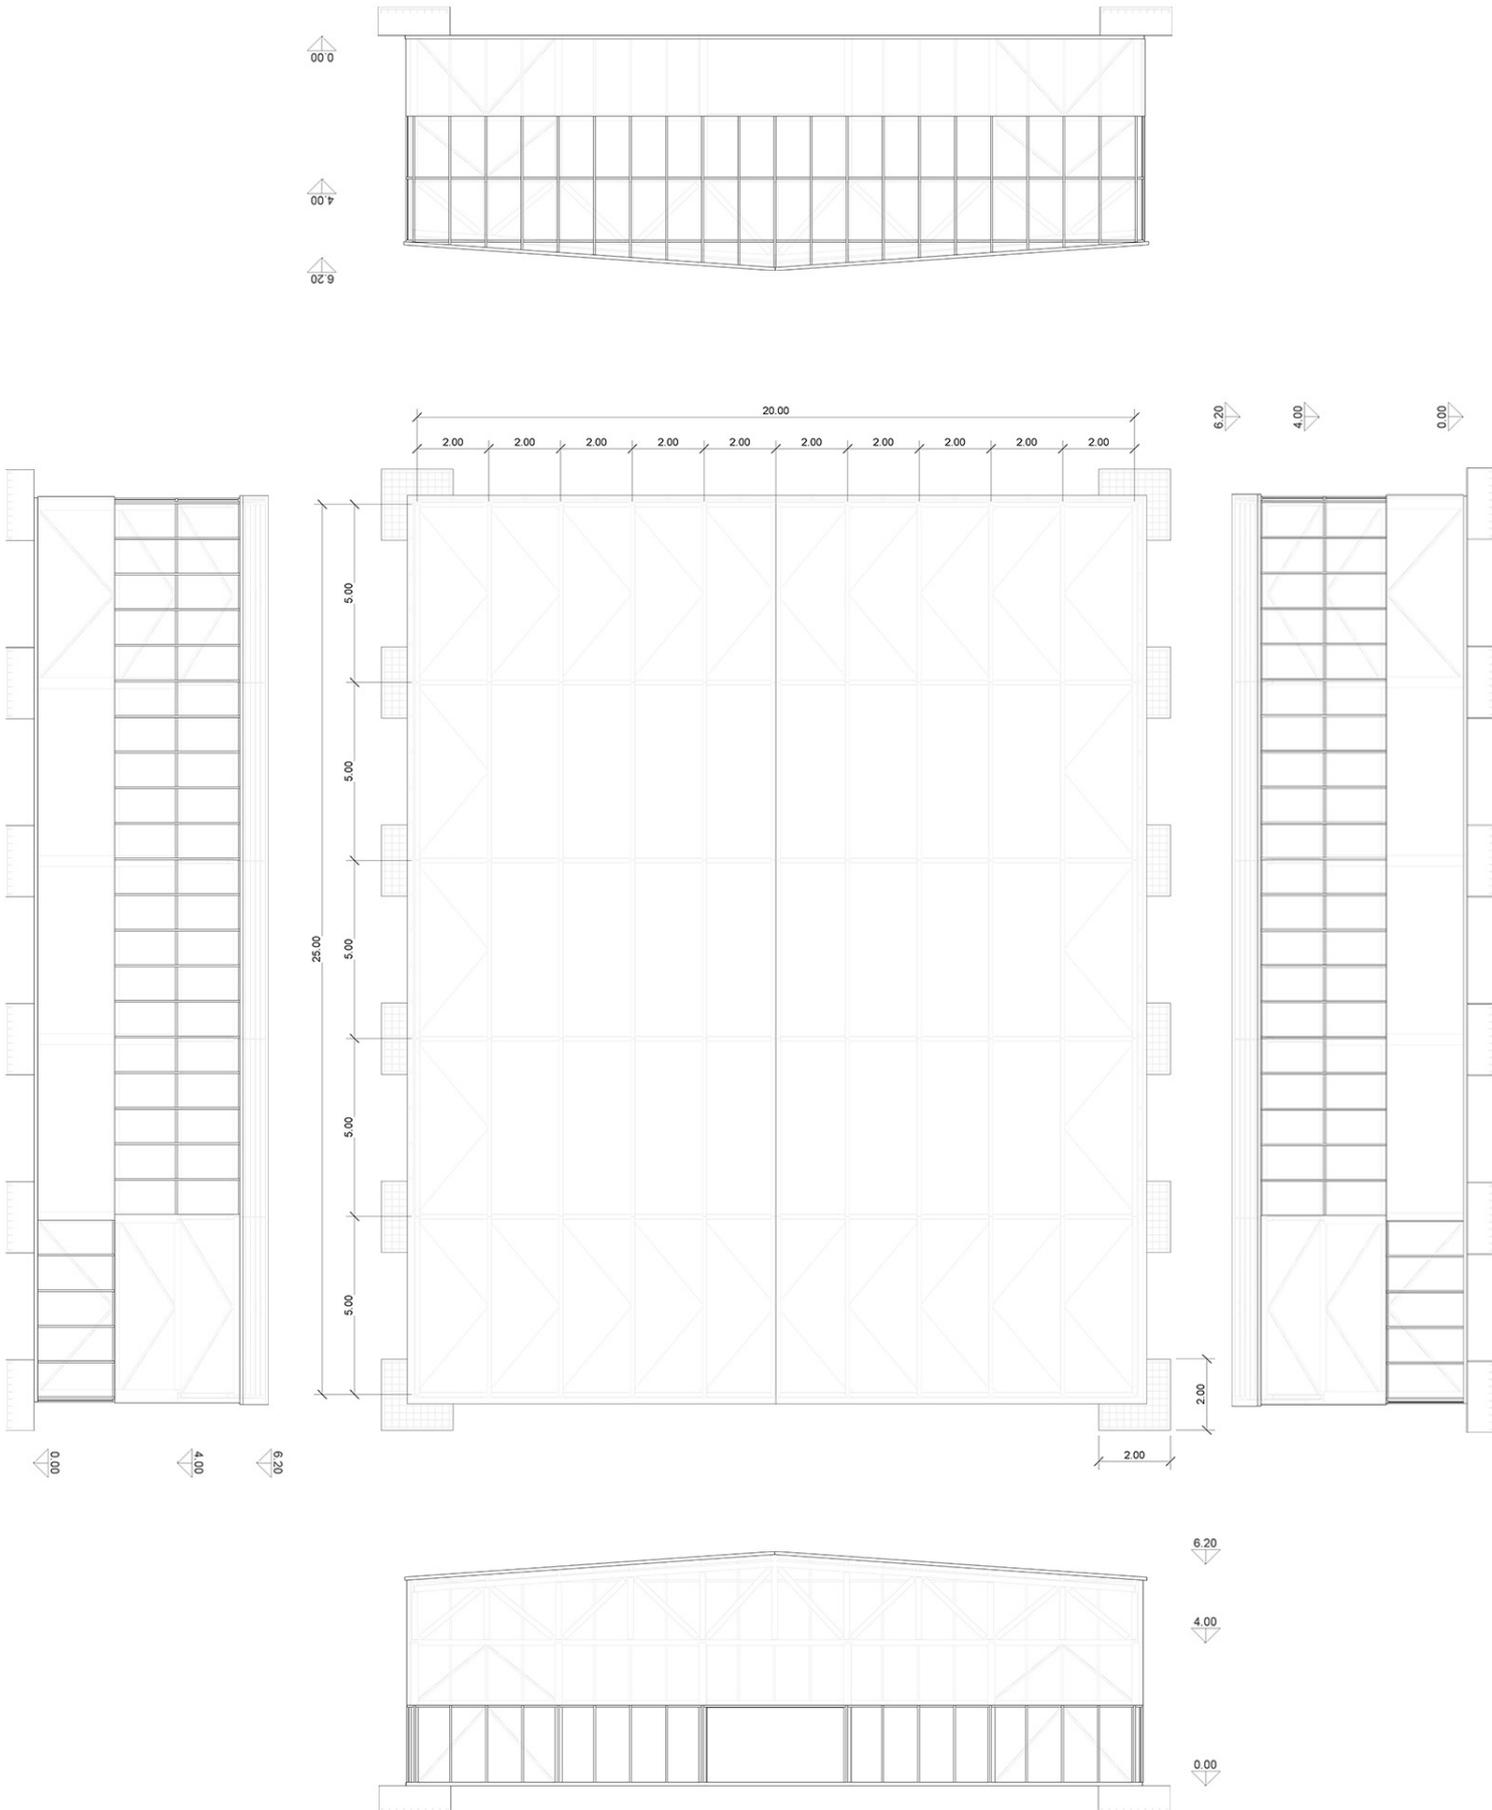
Planta y alzados de la propuesta (E 1:200 aprox).
